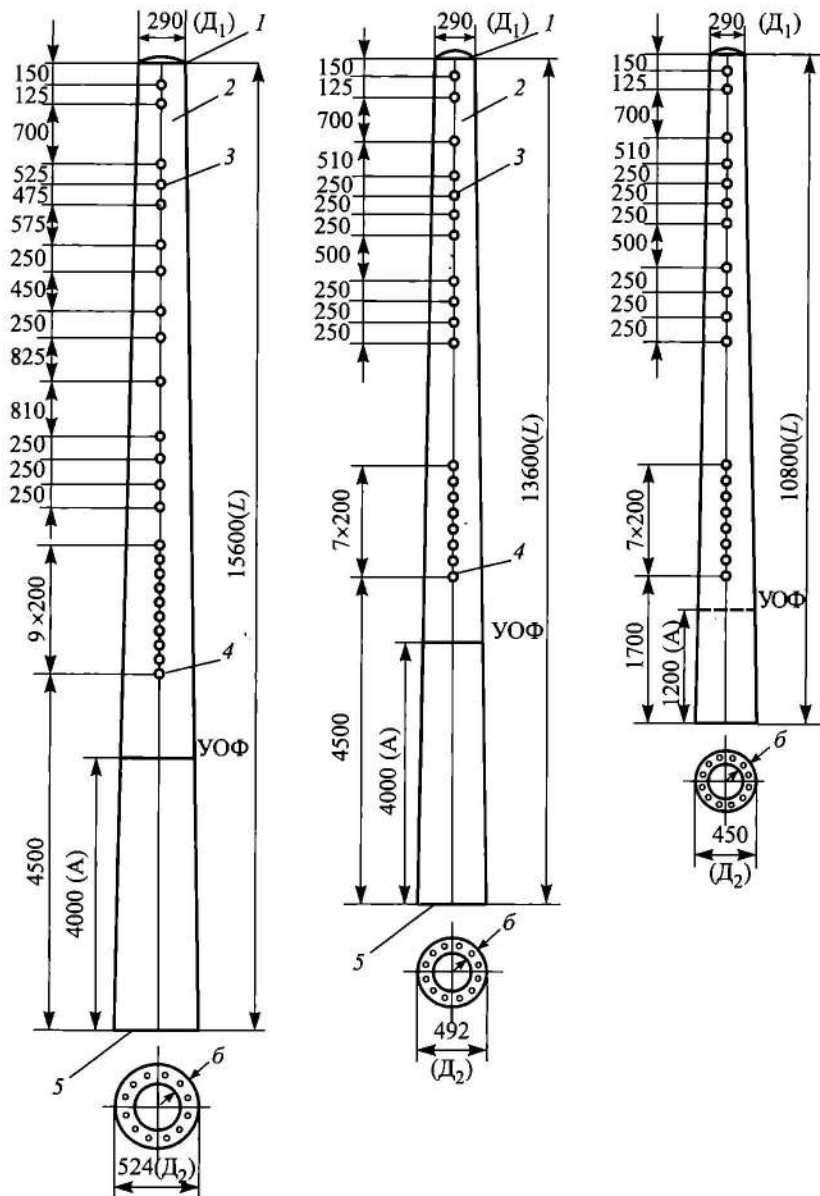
Железобетонная стойка типа С, СО:
